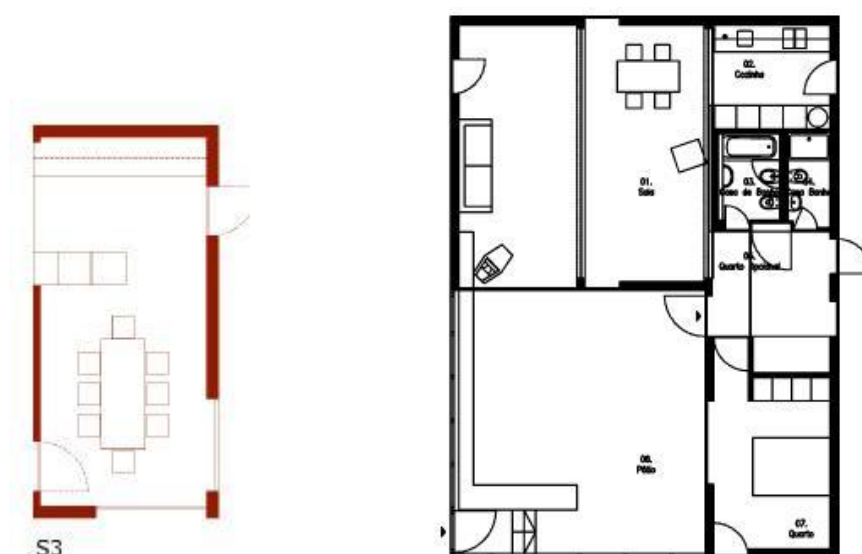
Exemplo de módulo isolado, sala de jantar – S3, e de uma planta disponível, T1.B [45]
